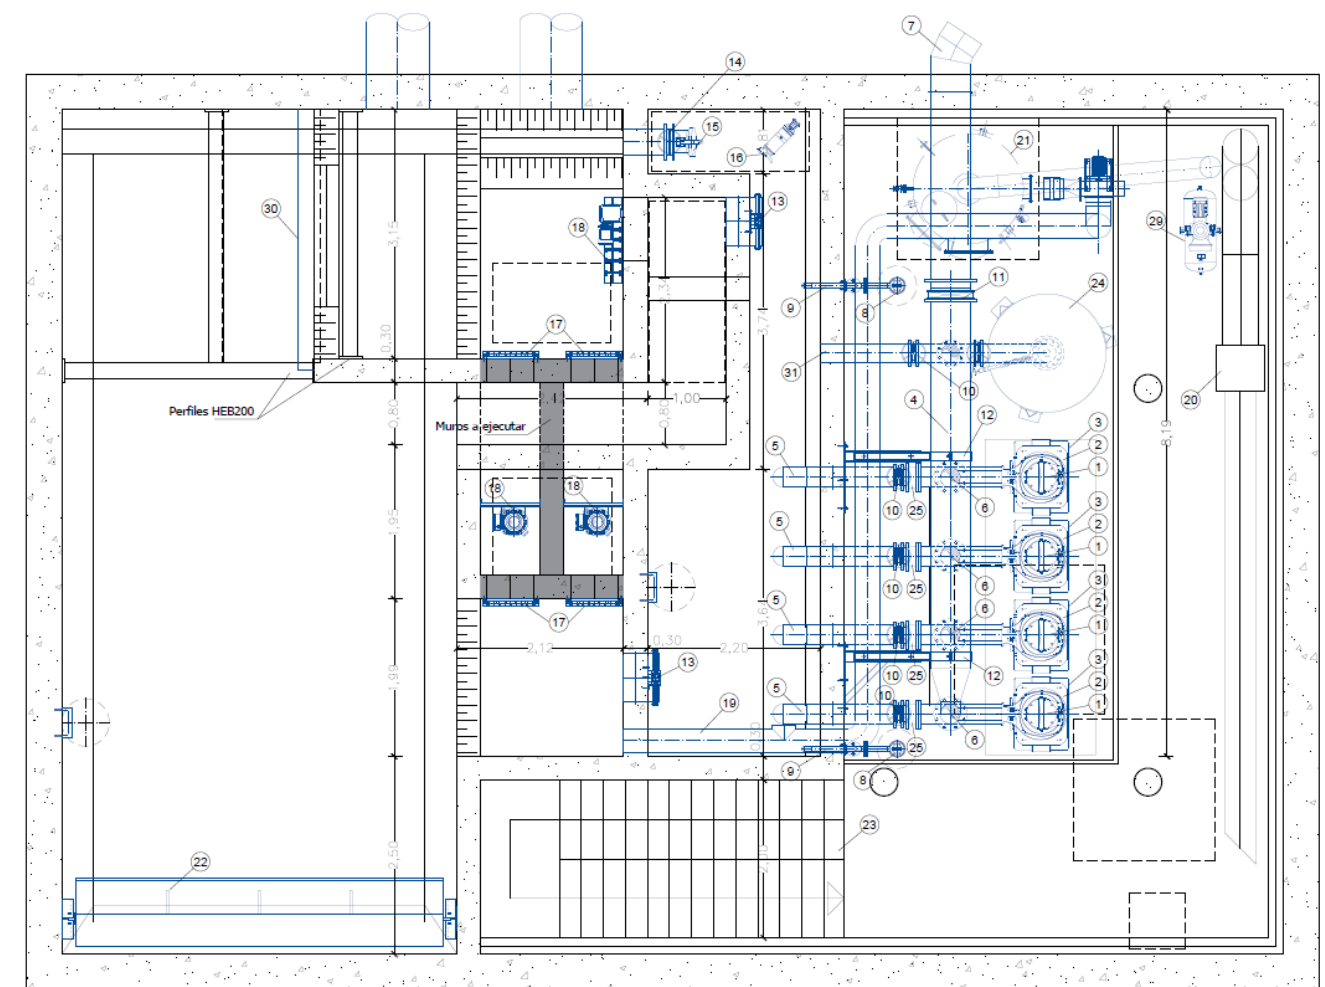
Planta del bombeo de Sanxenxo tras los trabajos proyectados
